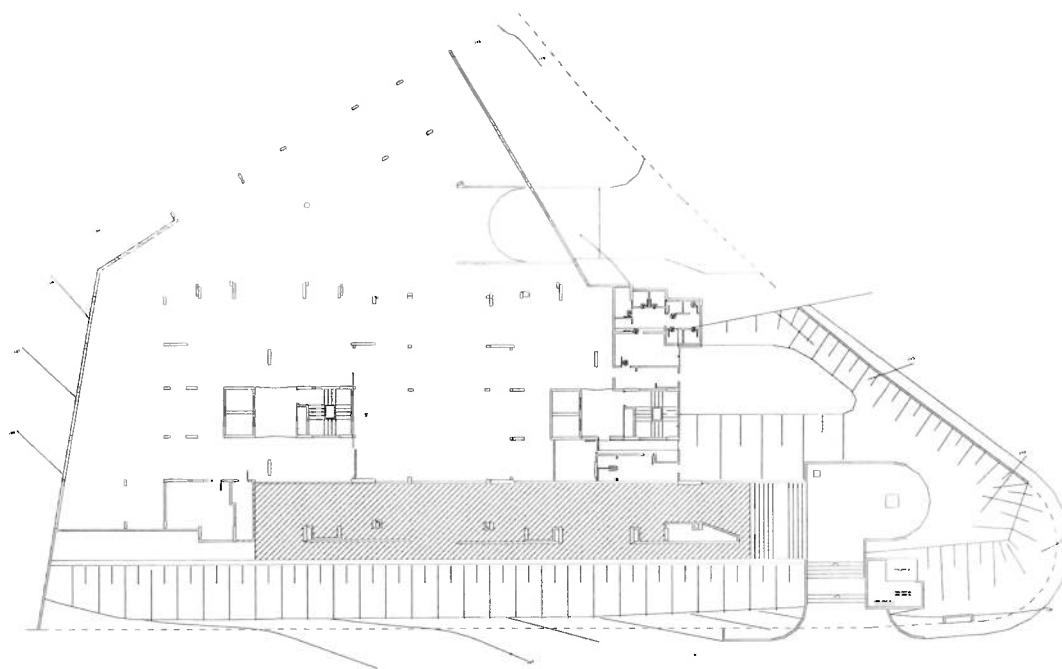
Planta do pavimento indicando, com hachuras, os ambientes onde o revestimento interno em gesso foi executado (Obra SP 58).
